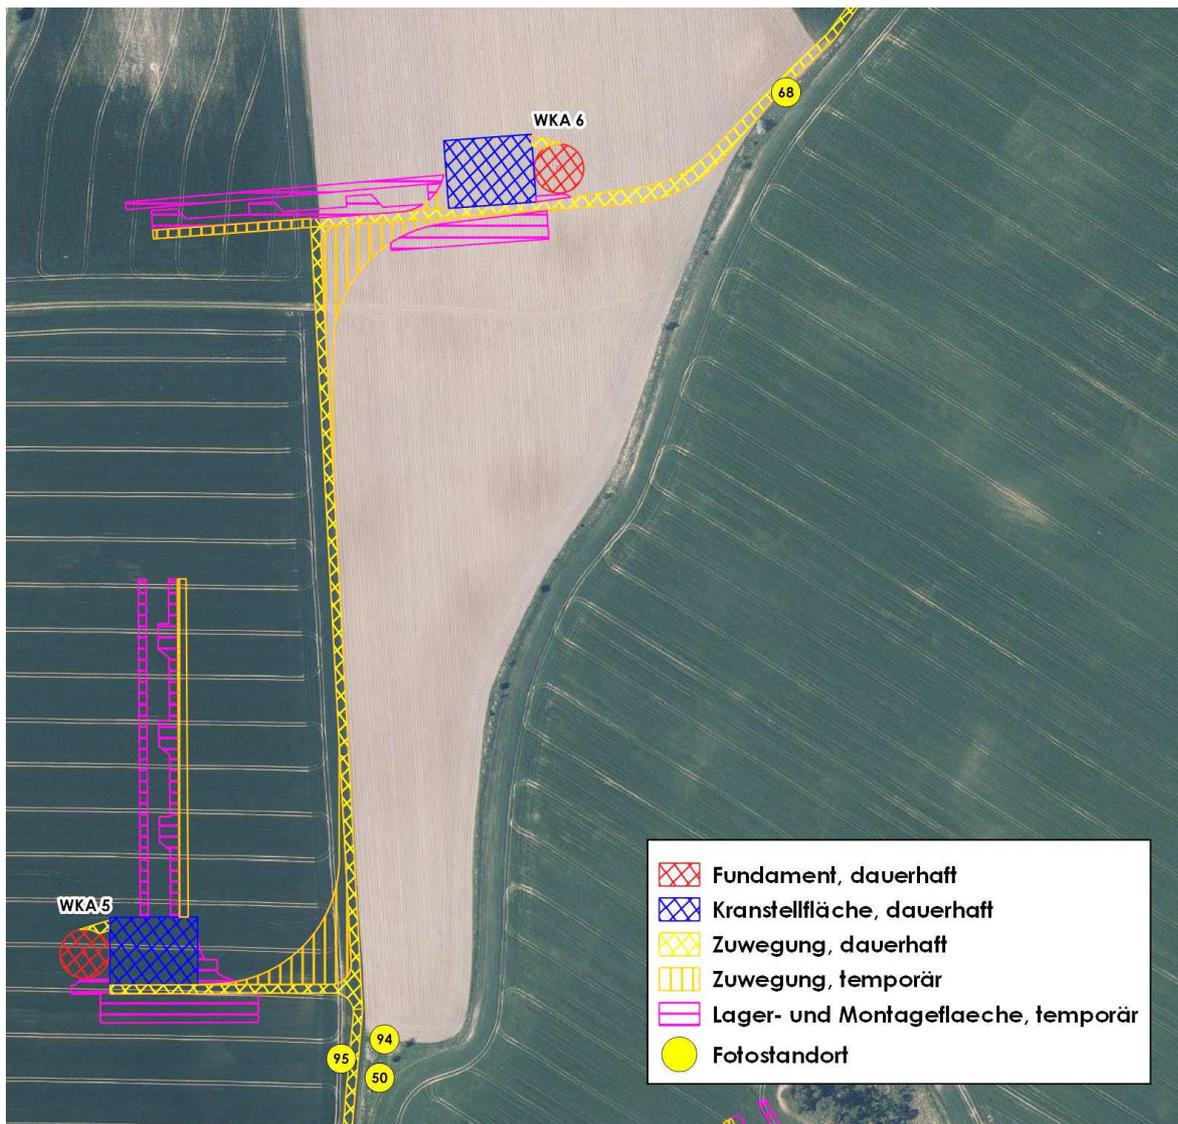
Luftbild mit geplanten Bauflächen der WKA 6 (oben) und 5 (unten)
